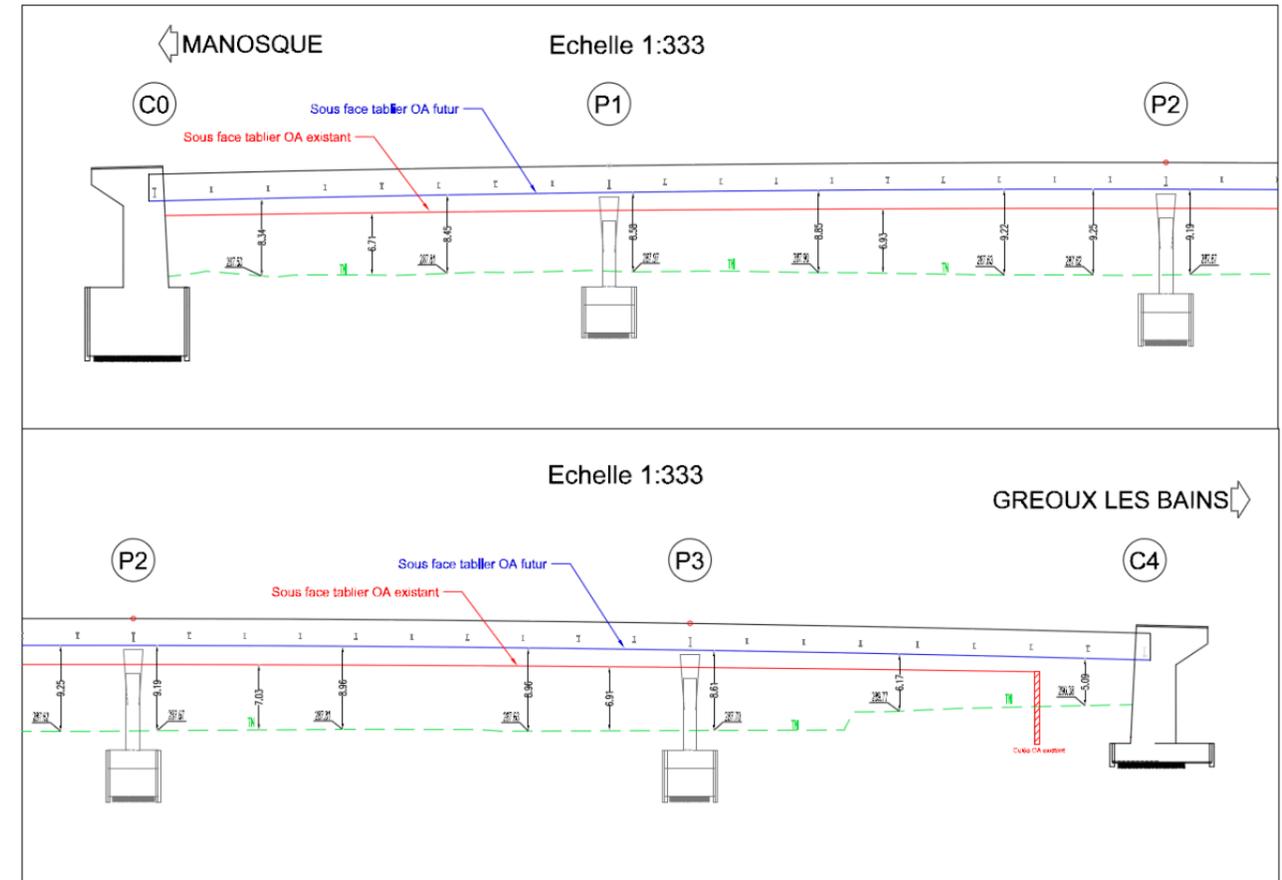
Plan d'élévation aval de l'ancien et du futur pont
